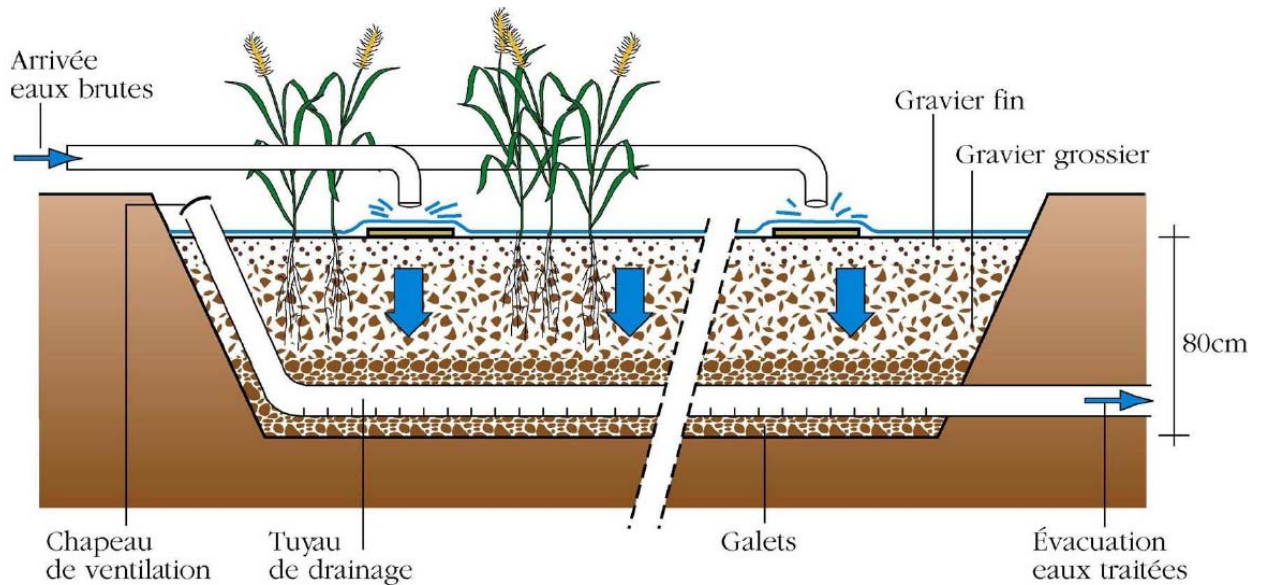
Coupe transversale schématique d'un filtre à écoulement vertical.
